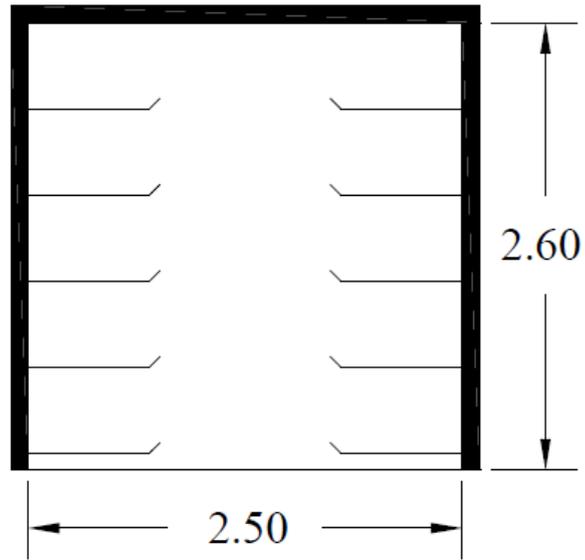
Vista frontal da estrutura cantilever para tubos.
